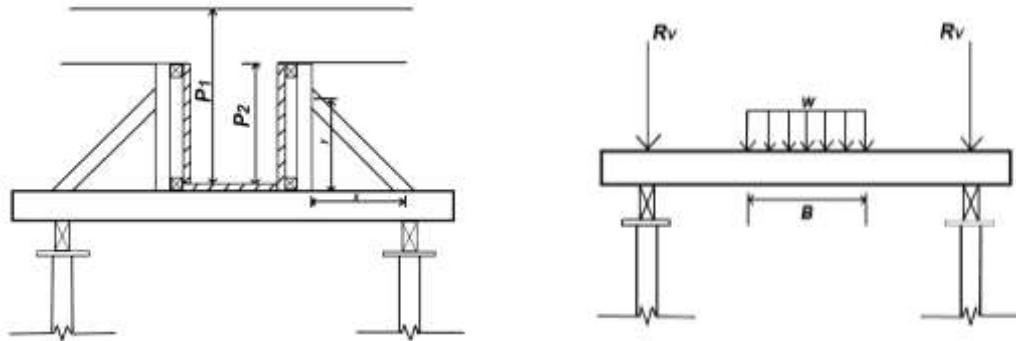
Sección transversal y reacciones en las vigas secundarias para un encofrado de vigas de concreto. Reyes, [Ilustraciones de encofrados, varias], (2020).
